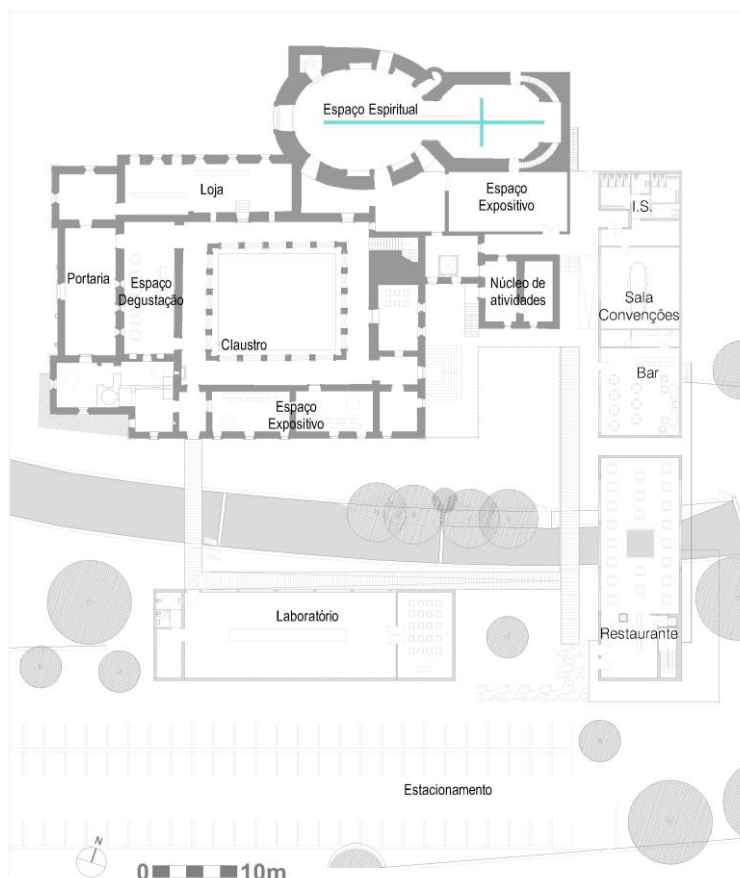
Planta da Proposta Piso 1. (Ver Anexo IV)
